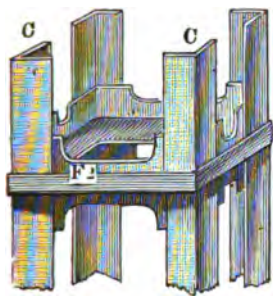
Principe du poteau à section carrée, syst. O. André.
